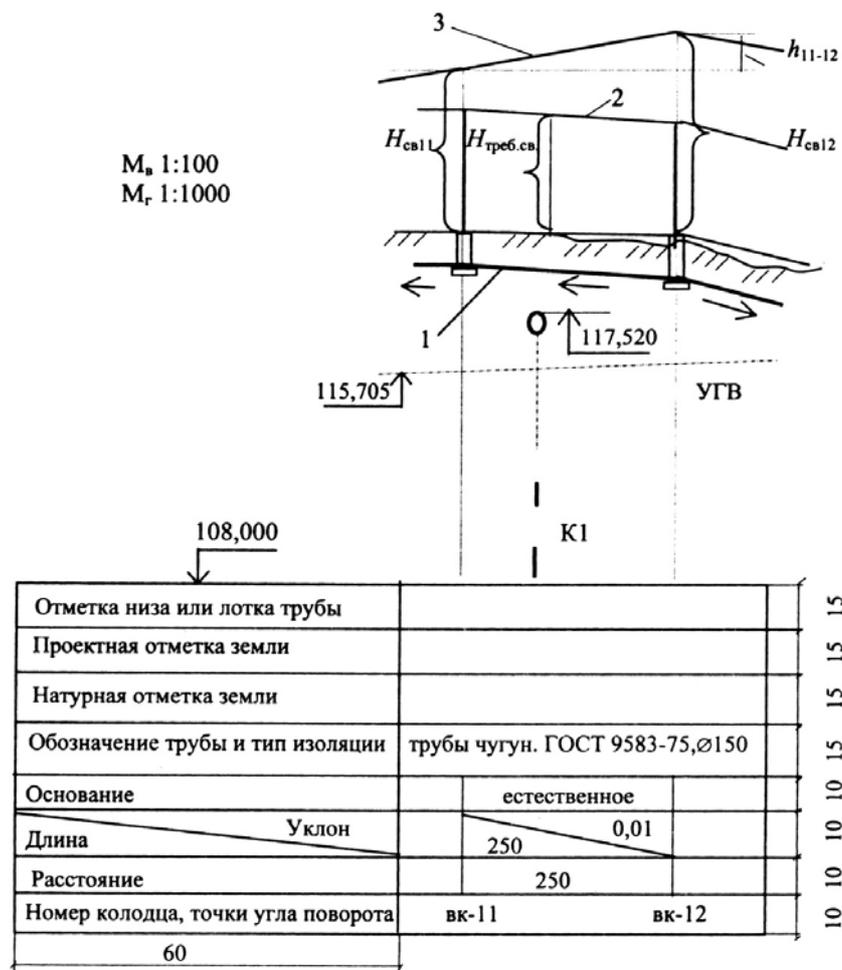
Фрагмент продольного профиля водопровода:
